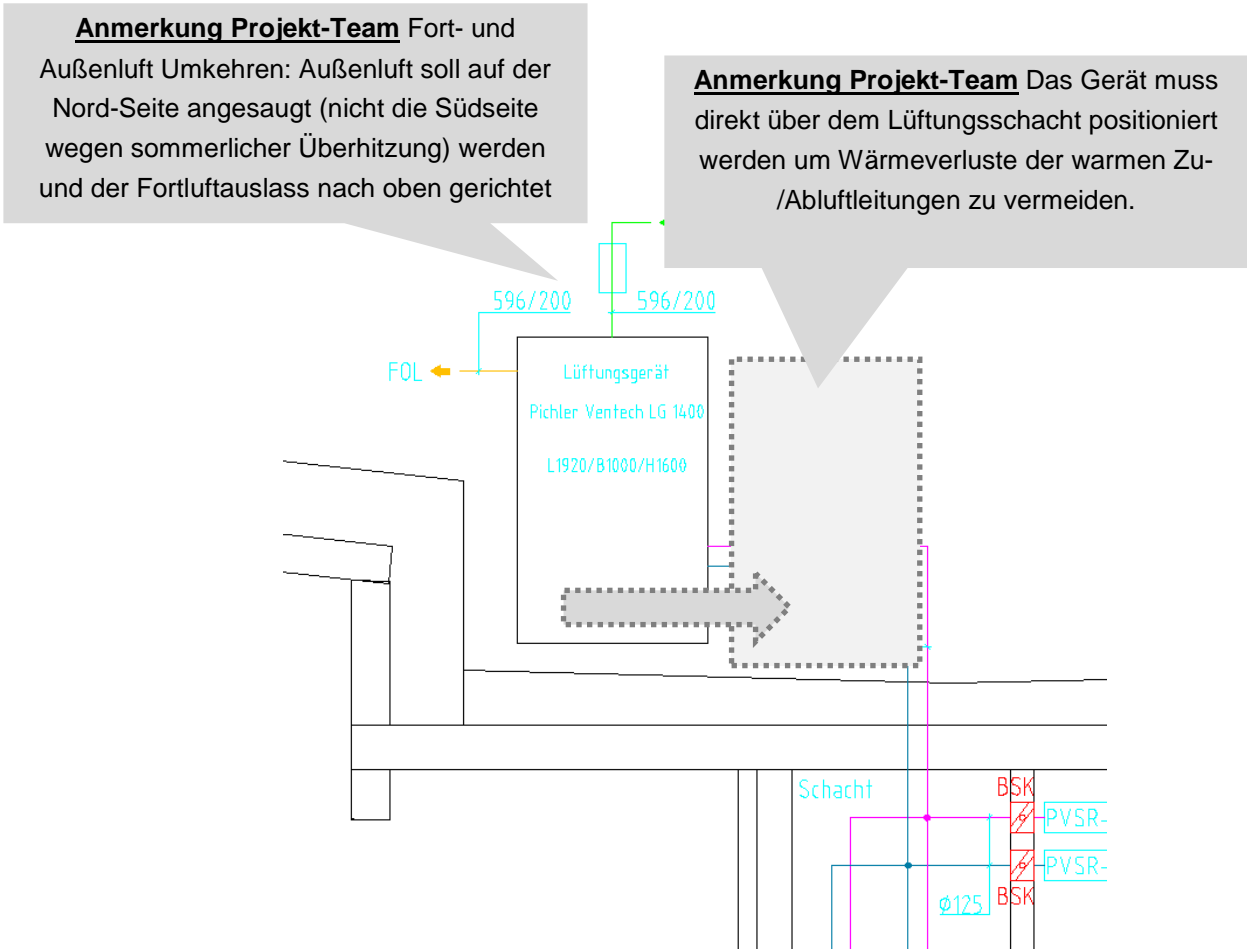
Detail aus dem Plan „Lüftungsschema Nordseite“ vom HLS Planung, Stand 07.03.2013
